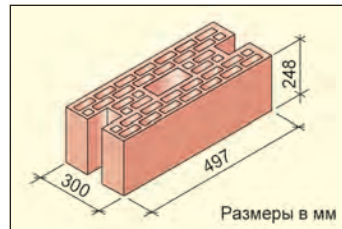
Шлифованный блок для изготовления стеновых панелей
